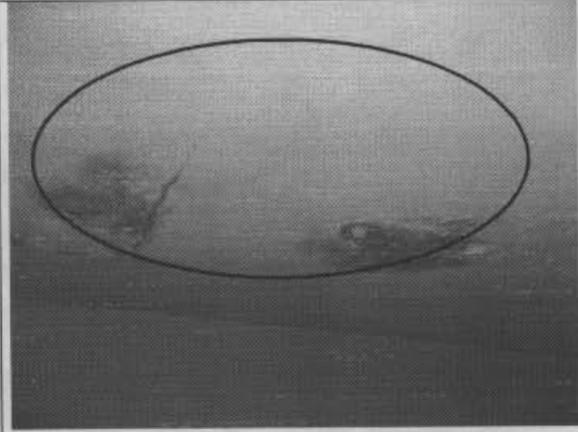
Deflexiones en cielo raso bajo la estructura de cubierta y desprendimiento de acabado.
